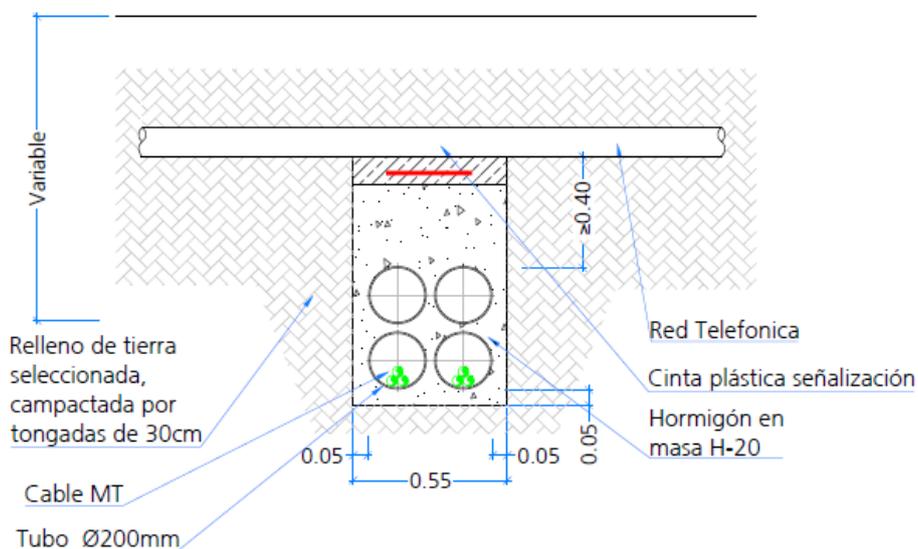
Características constructivas de la zanja en cruce con canalizaciones de red telefónica.
